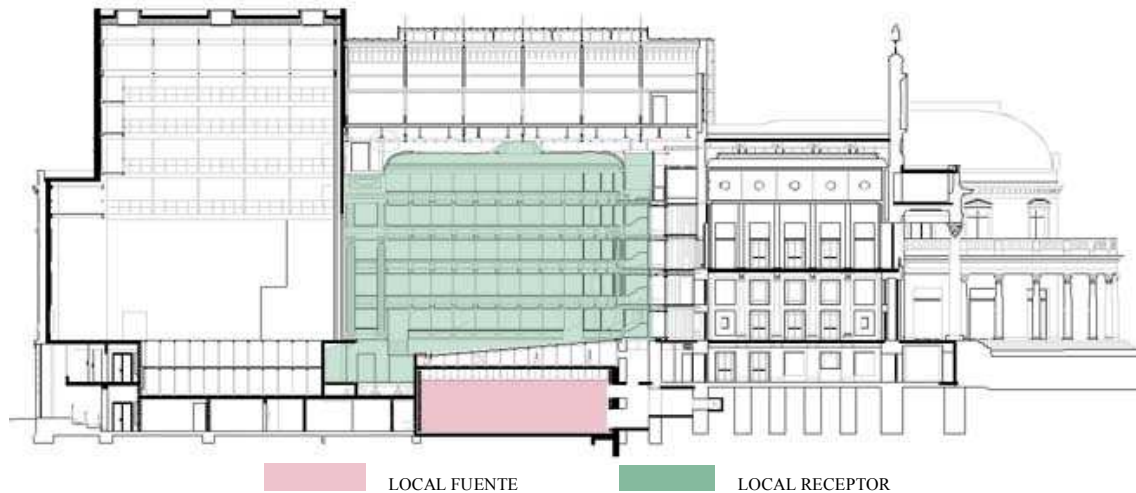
Corte longitudinal. LOCAL FUENTE DEBAJO DE LOCAL RECEPTOR.
